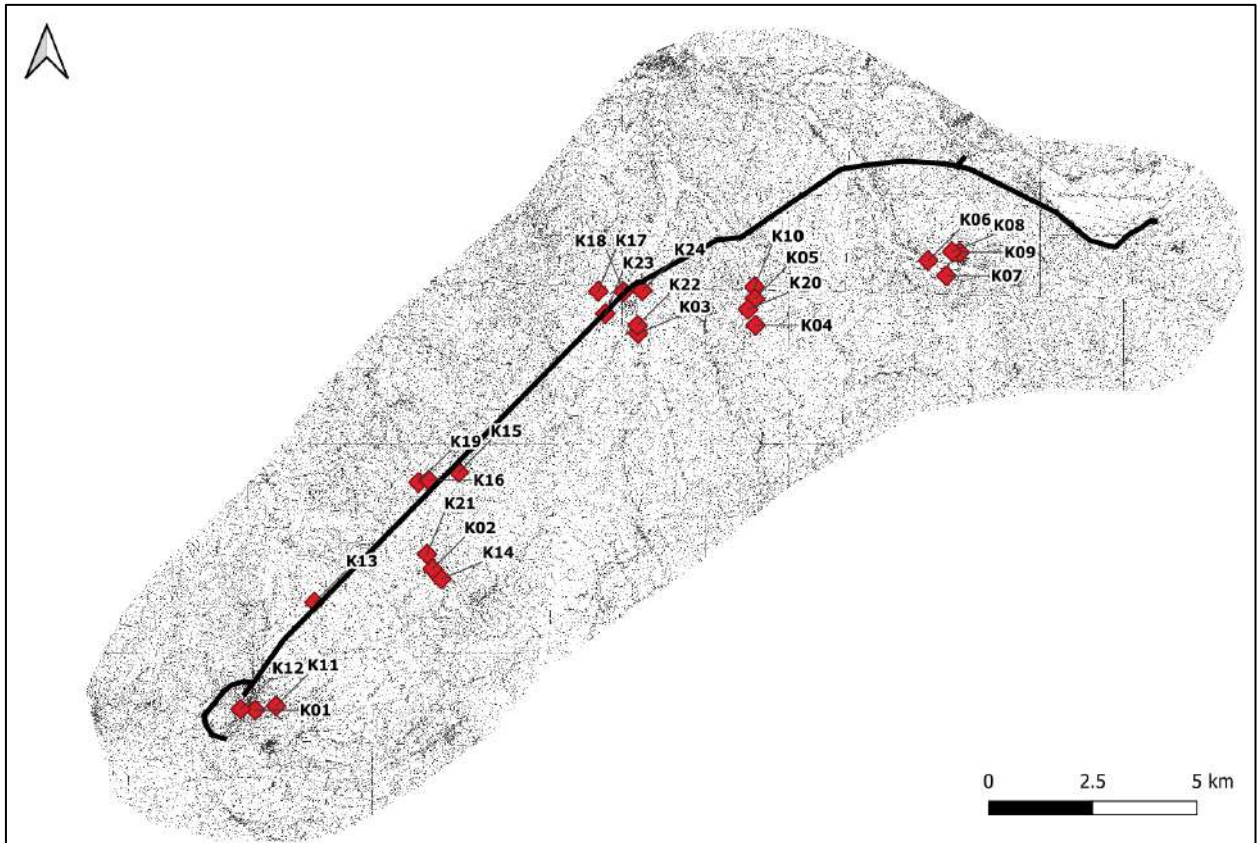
Vista planimetrica riportante l'ubicazione delle stazioni geomeccaniche effettuate, unitamente al tracciato di progetto.
